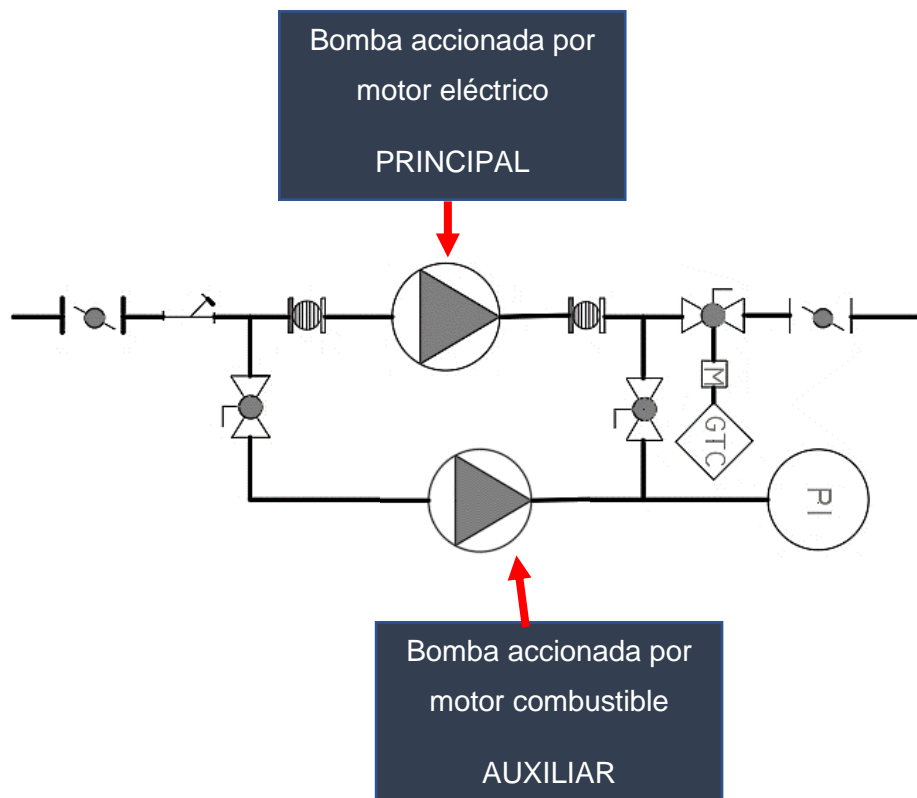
Sistema auxiliar para bombas en paralelo. Fuente: Adaptado de [54].
